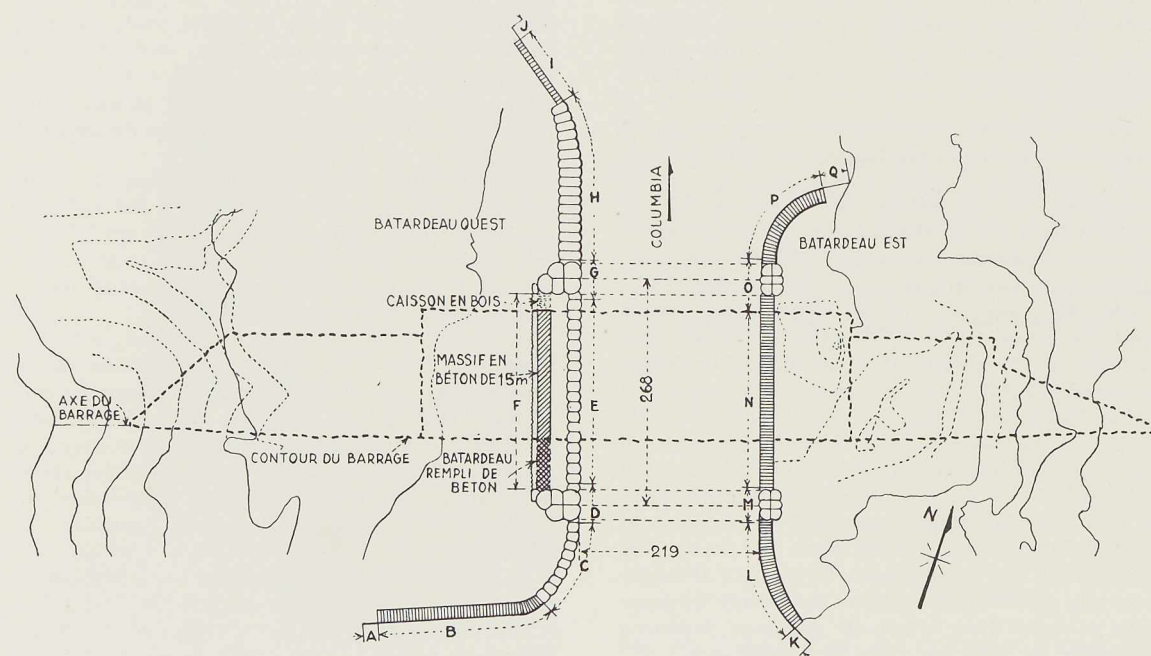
Plan montrant les dispositions des deux premiers batardeaux.
